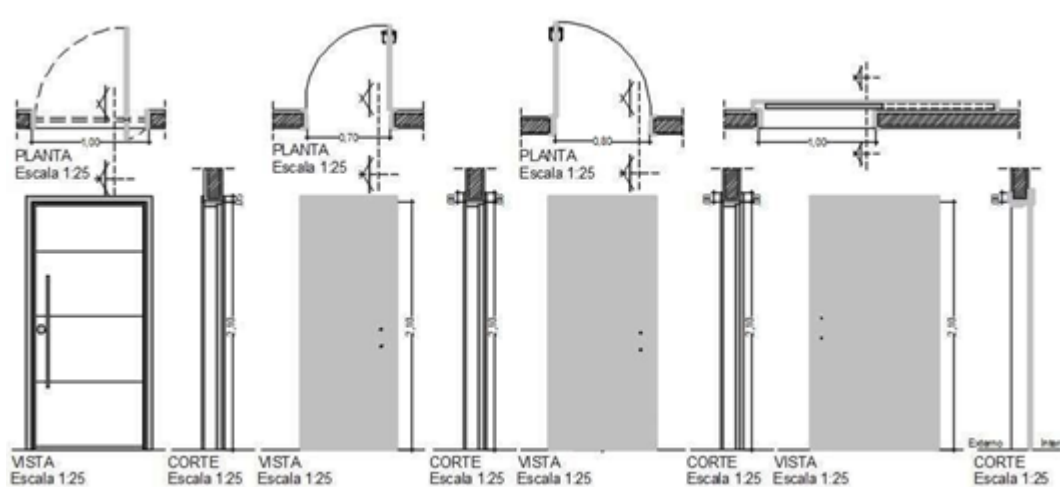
Приклад позначення відкриття дверей на кресленні плану.
